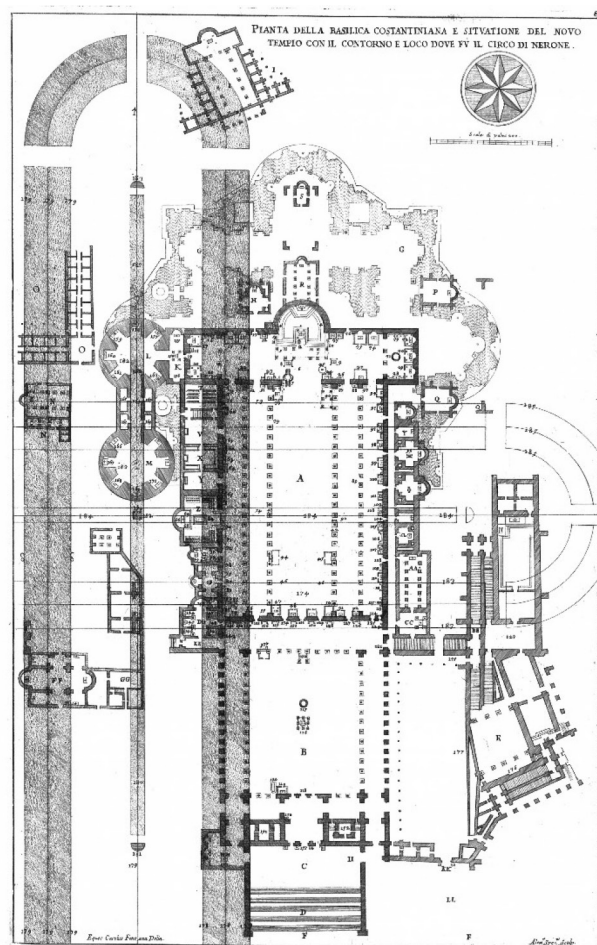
フォンターナ作図, アルファラーニの平面図を利用したネロのキルクス、新旧のサン・ピエトロ大聖堂平面図
